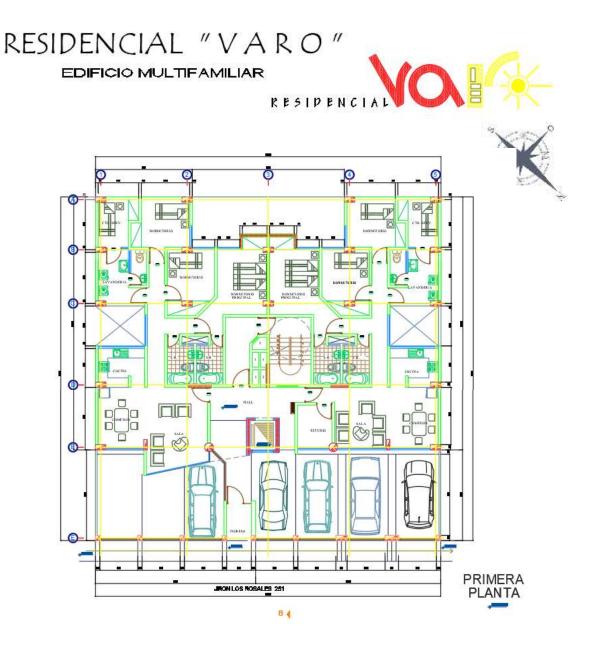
PLANO DE DISTRIBUCIÓN PLANTA TÍPICA RESIDENCIA VARO
